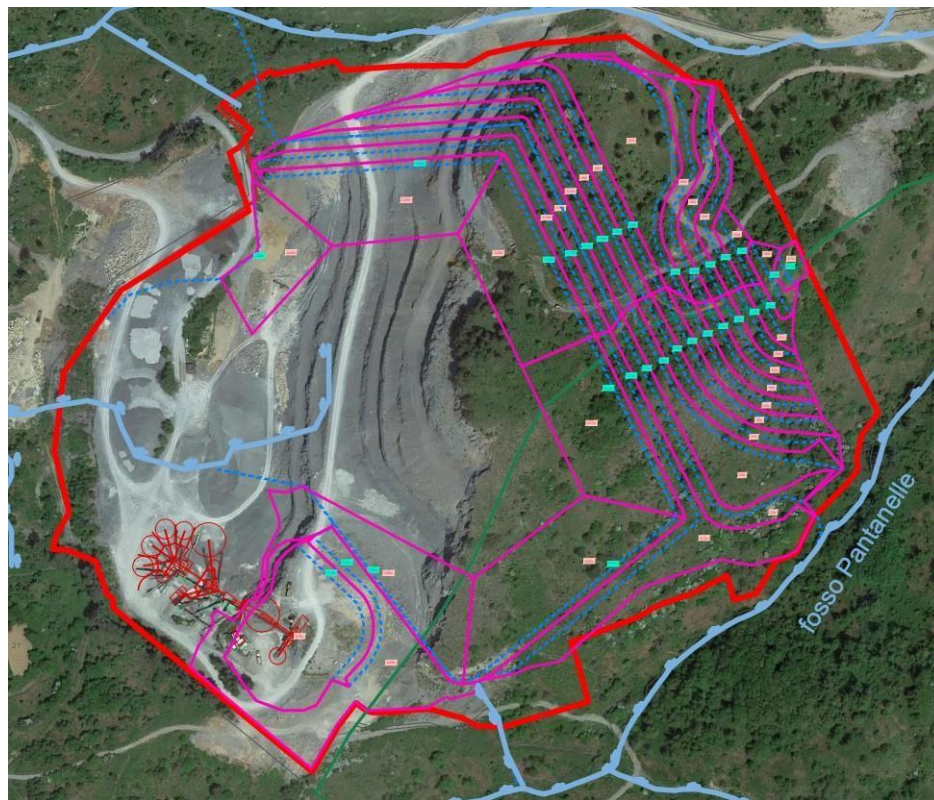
Planimetria Recapito Finale Acque Meteoriche Stato Finale
